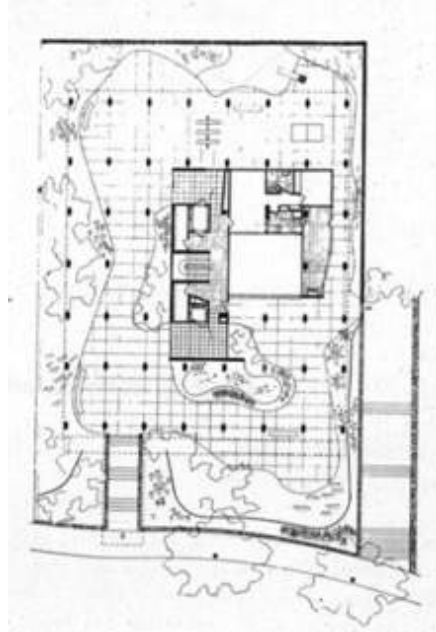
Edificio residencial en R o de Janeiro proyectado por el arquitecto Jorge Machado Moreira. 1952. Planta del primer piso. (Imagen tomada del libro Latin American Architecture since 1945. Henry-Russell Hitchcock. 1955.)
